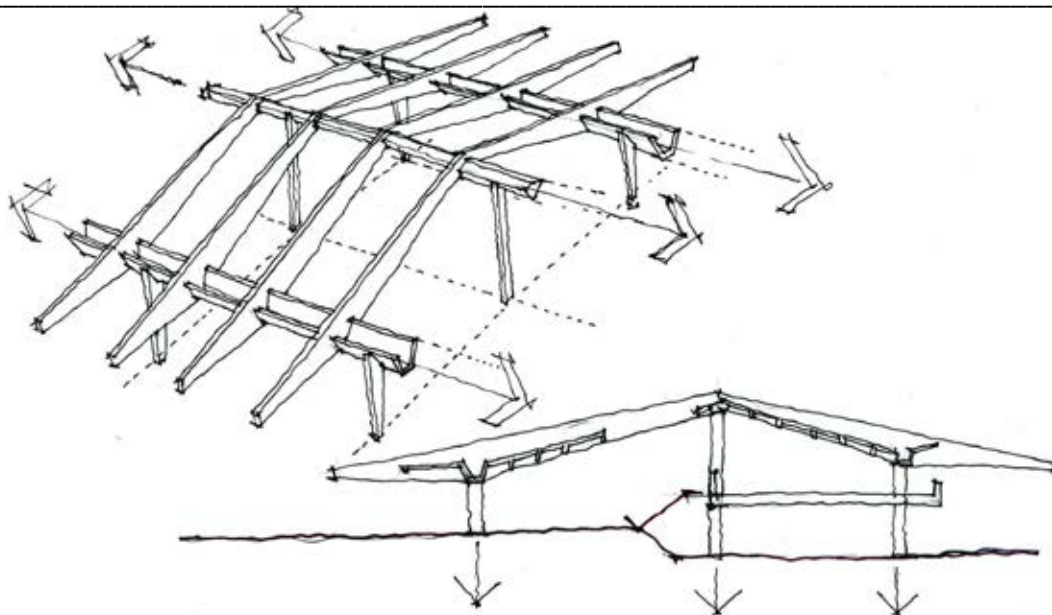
representação da estrutura em concreto armado e aparente, utilizada na casa. Observar as vigas calha capazes de suportar grande vão. Estas, por sua vez, apóiam várias vigas planas e paralelas que se lançam em balanço.
